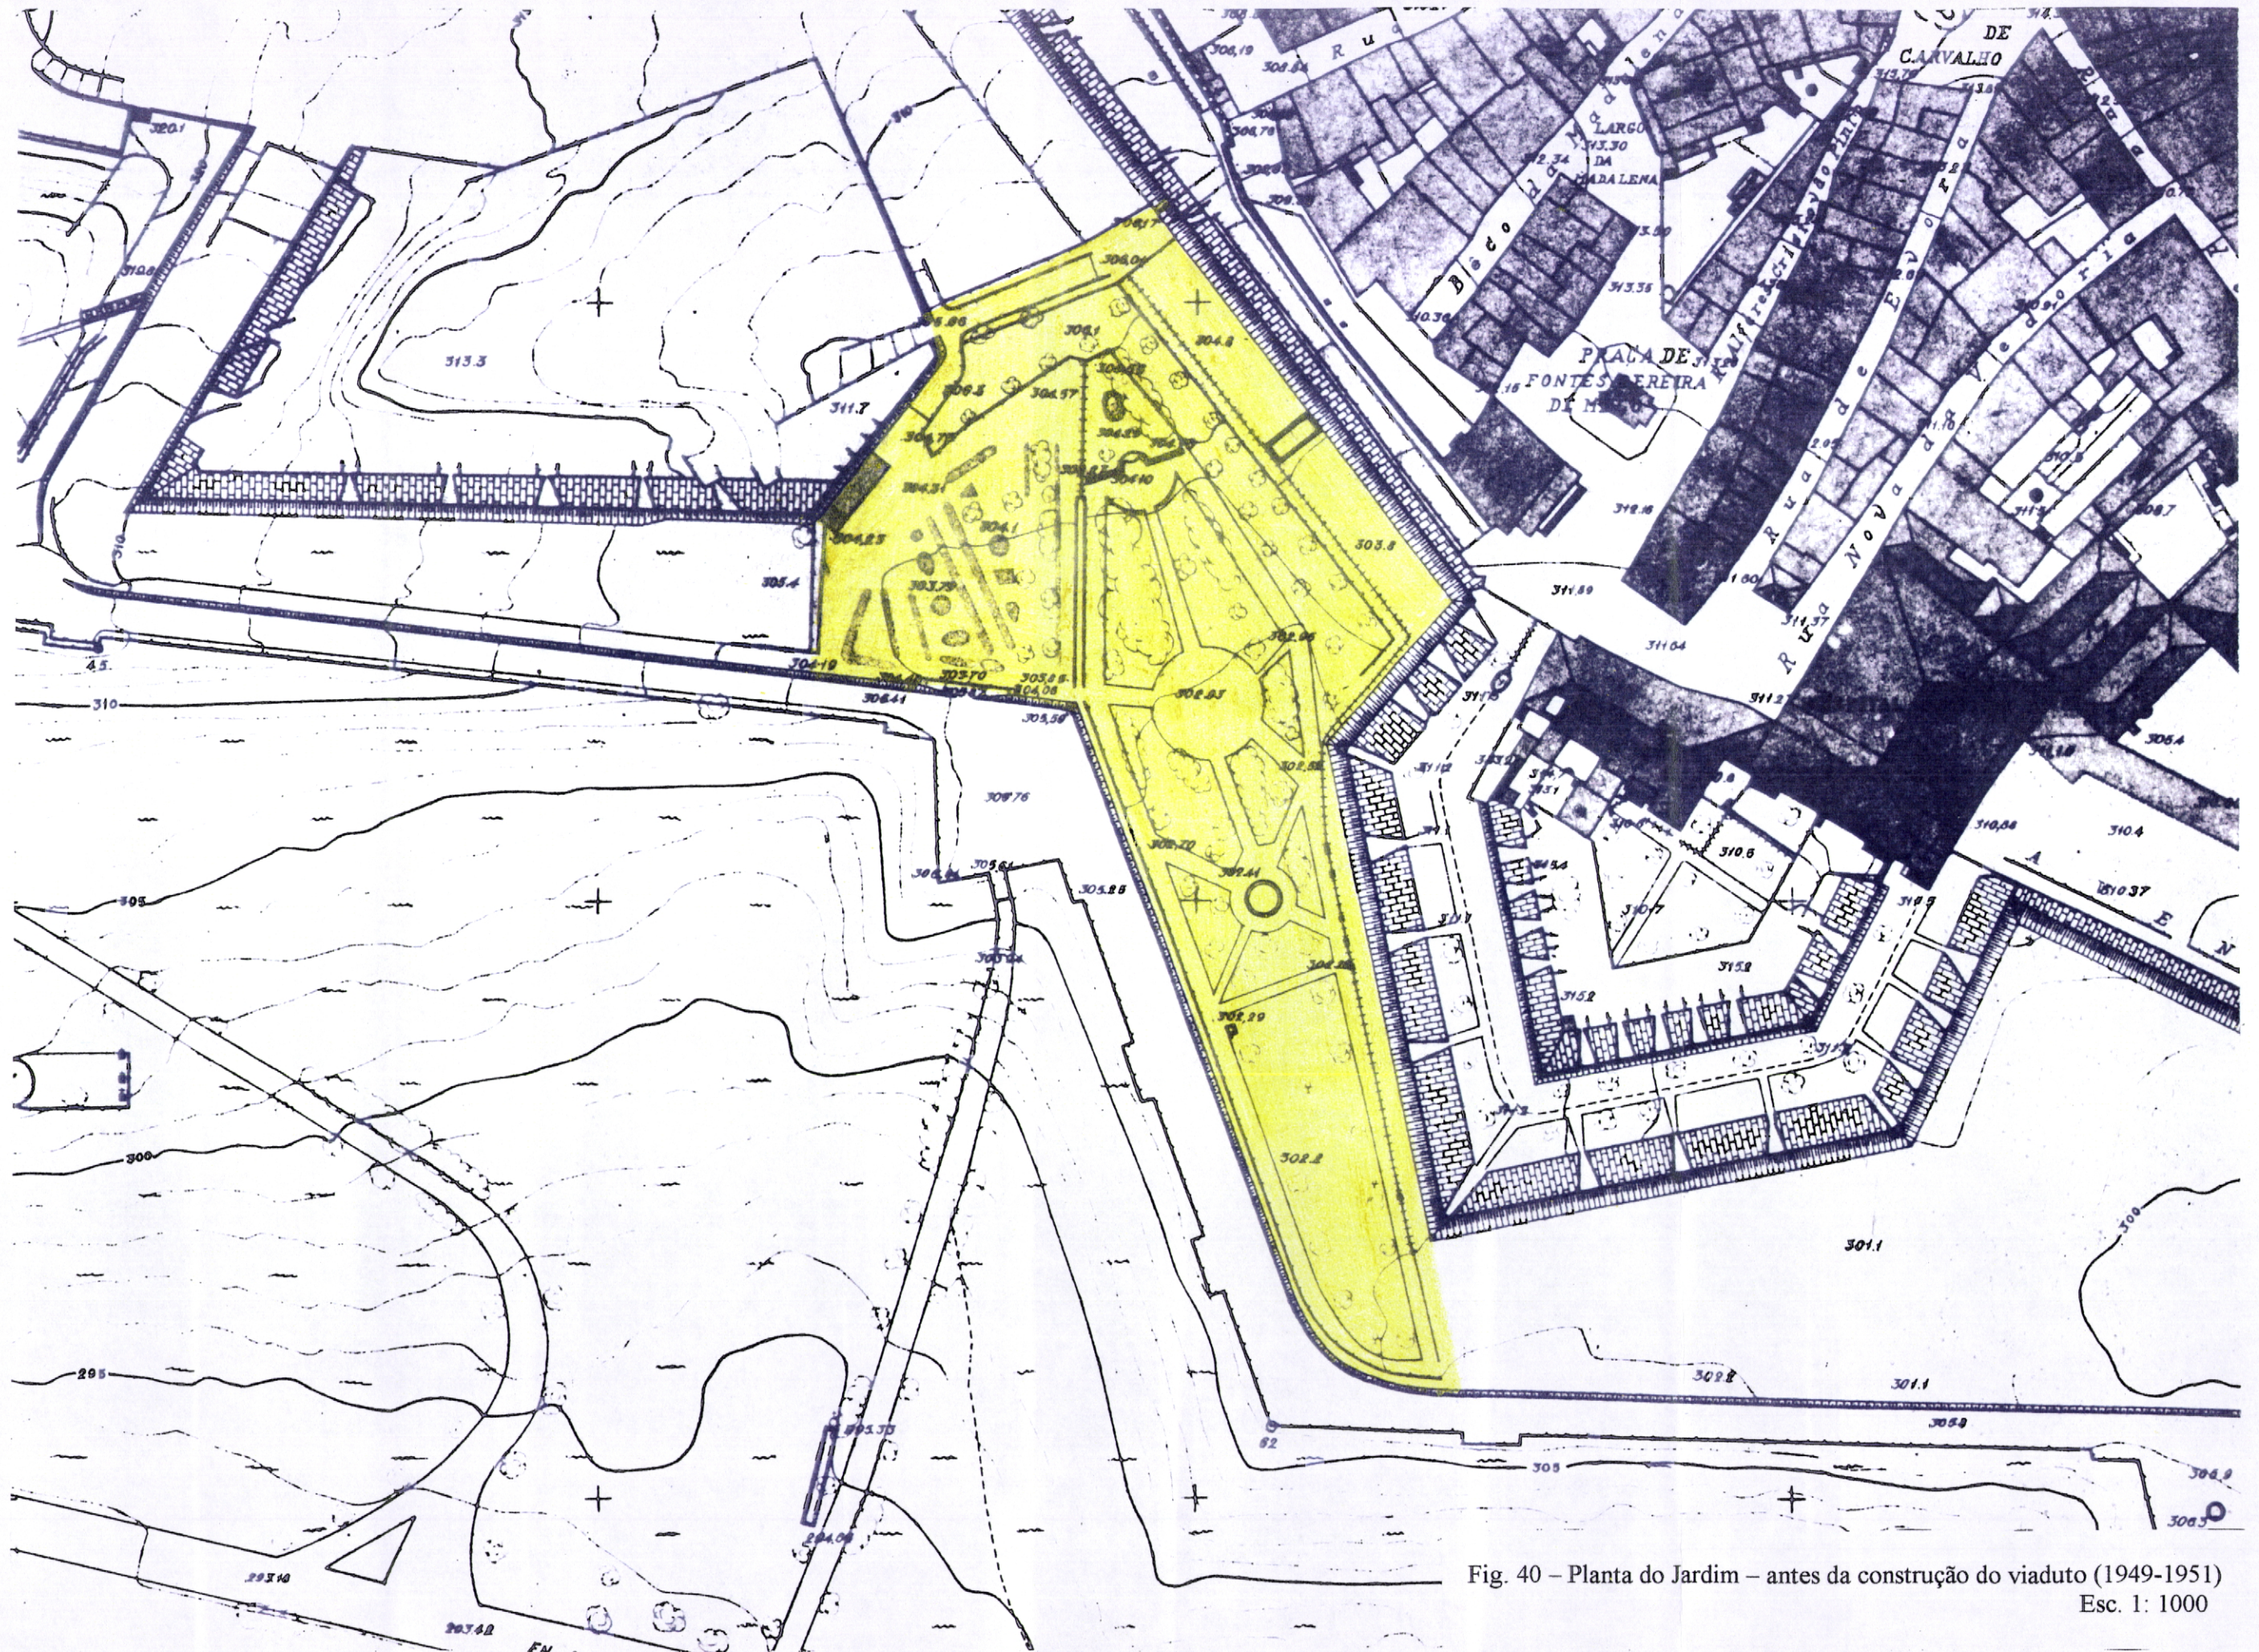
Planta do Jardim - antes da construção do viaduto (1949-1951)
